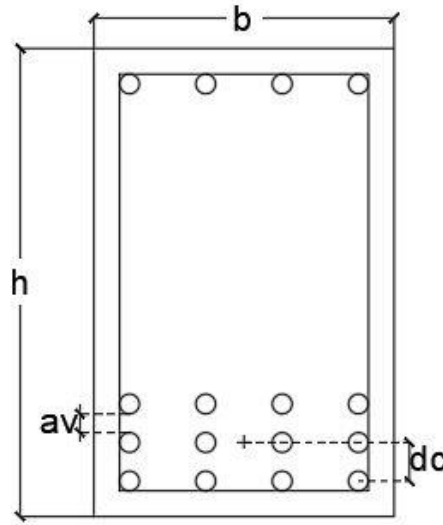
Espaçamentos verticais na seção transversal da viga (Elaborado pela autora, 2018)
